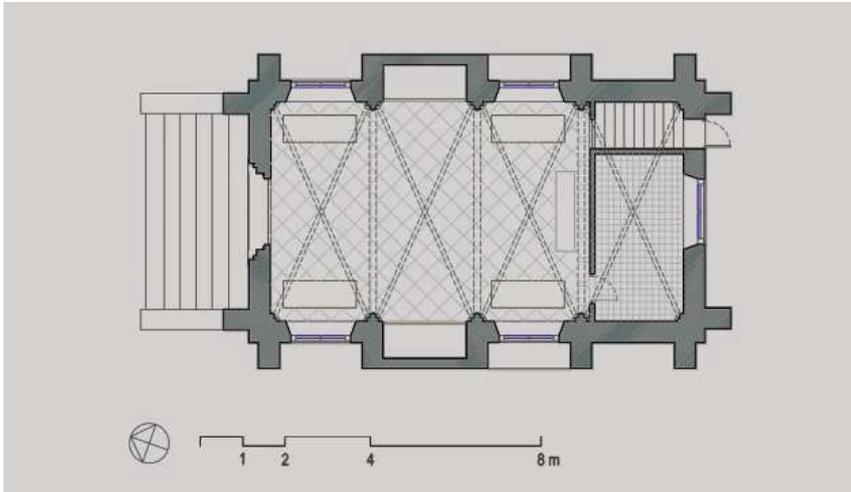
Planta de la nave, capilla sepulcral, del Panteón en su estado actual, elaboración propia.
